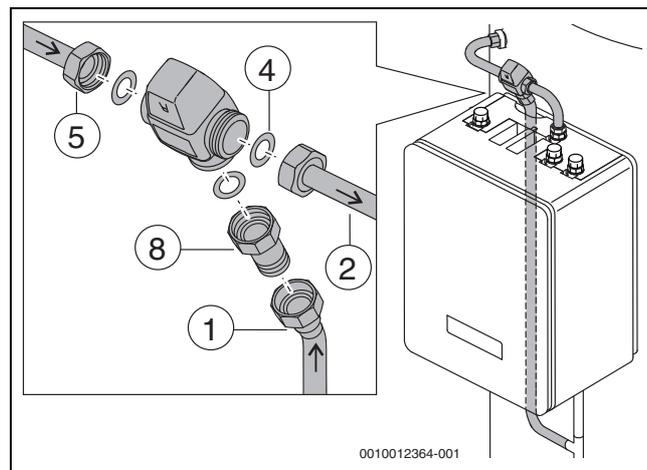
Serrare saldamente a mano i tubi di raccordo
